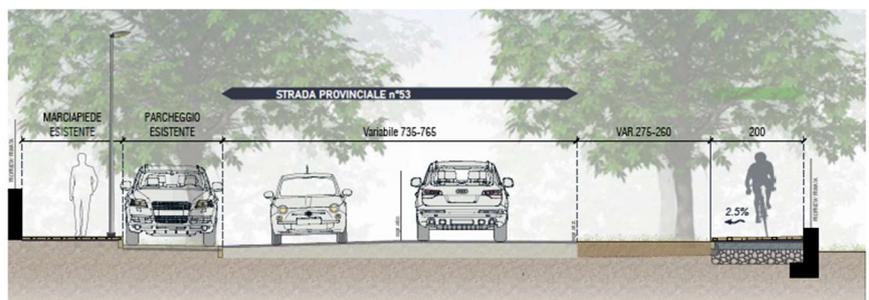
Sezione tipo con pavimentazione in autobloccanti
